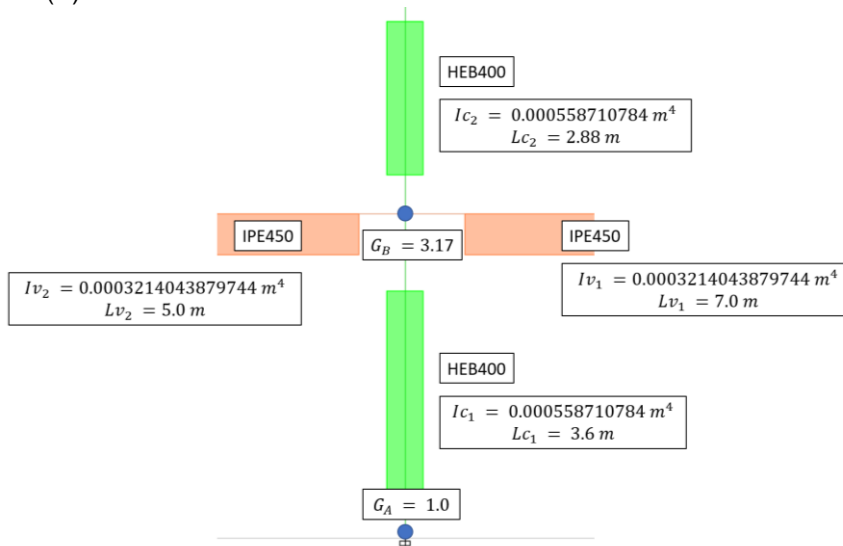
Detalle de valores involucrados en el cálculo de K para la columna de planta baja en el eje B.
